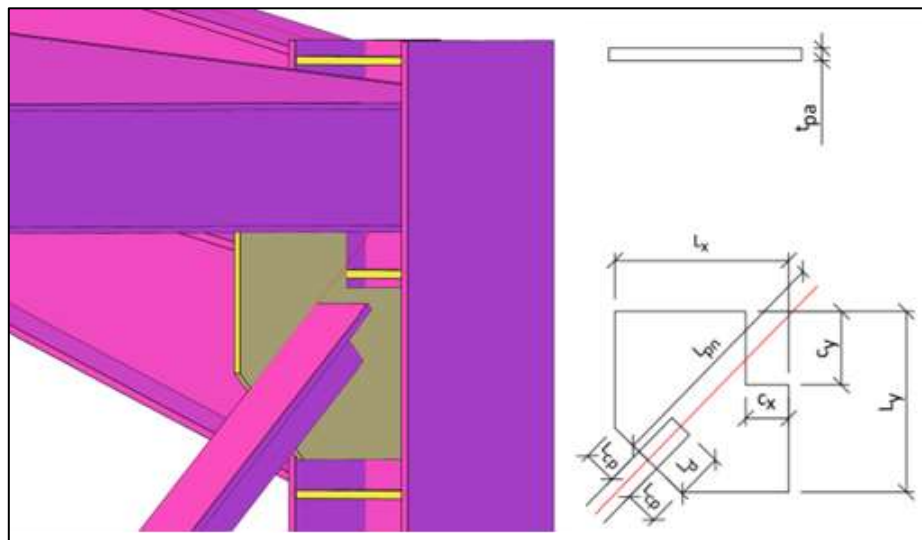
Conexión a corte Arriostre – Columna (Perfiles: alma llena)
